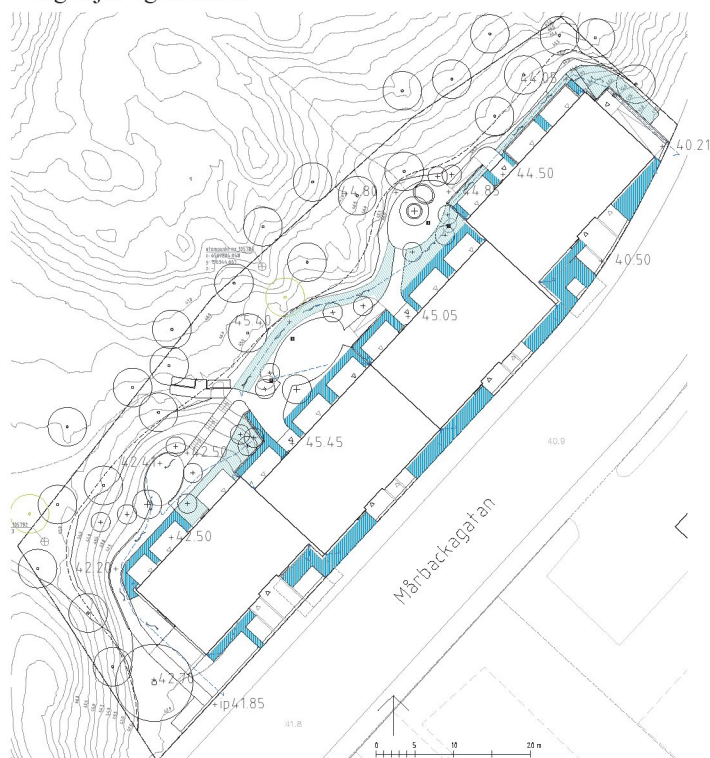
Plan dagvattenstruktur, del 2 (Hus C-F).
